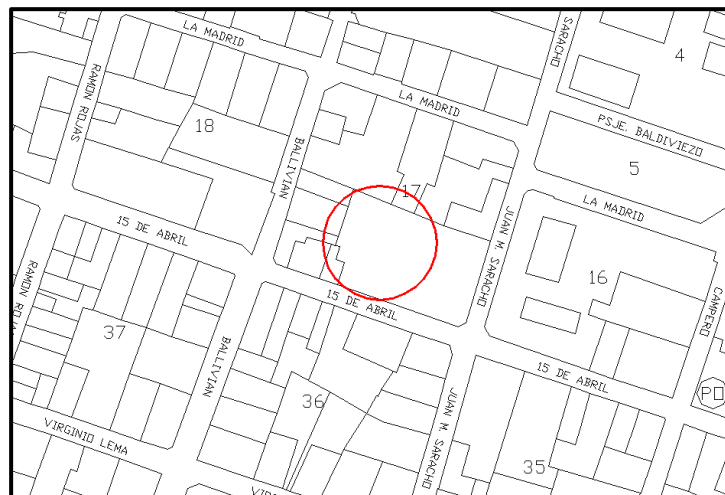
; Ubicación en la Ciudad del Proyecto, Elaboración Propia
